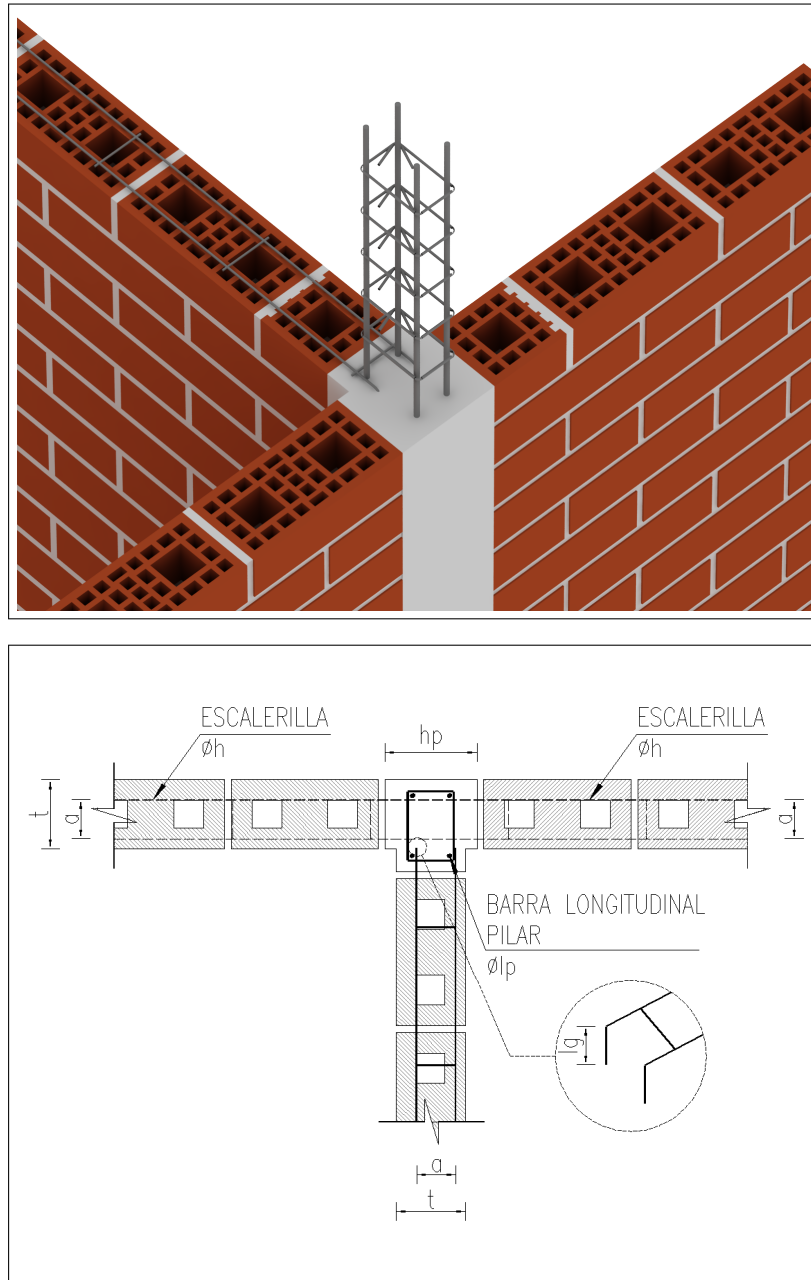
Detalle de las escalerillas para el encuentro de muros en T
